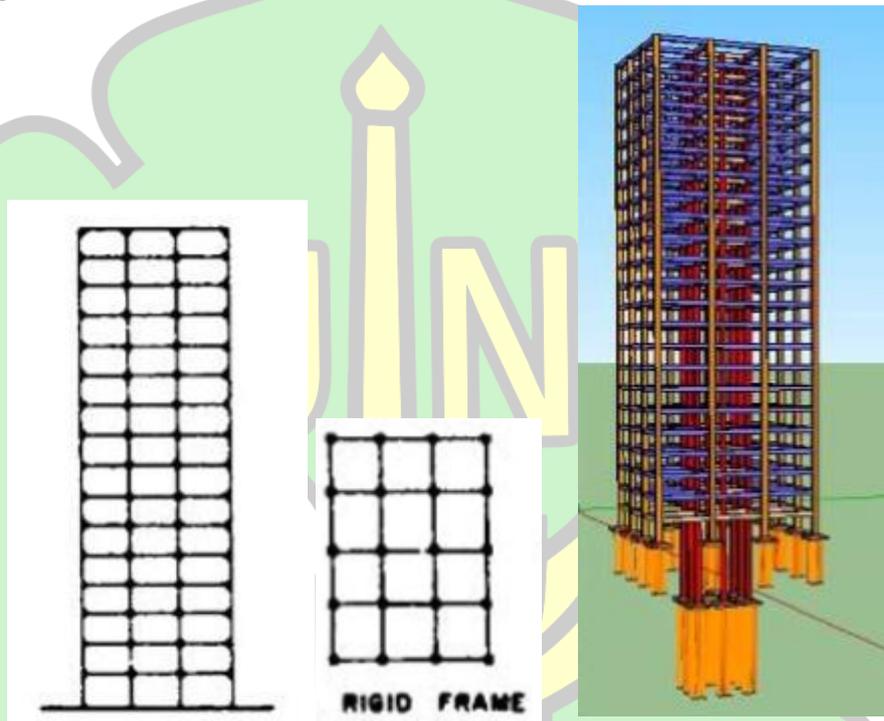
Penggabungan Pondasi dengan Basement
